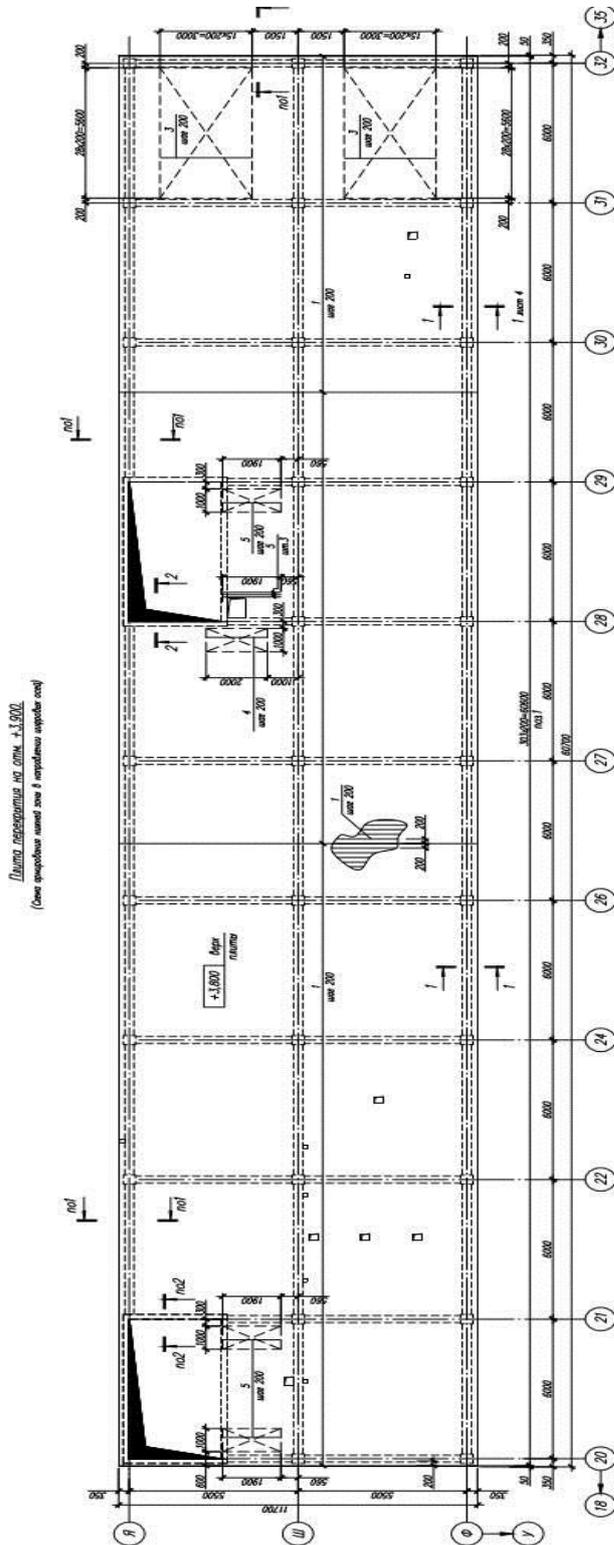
Раскладка сеток армирования плиты и опорных сеток второстепенной балки (штриховкой выделены двойные сетки)
